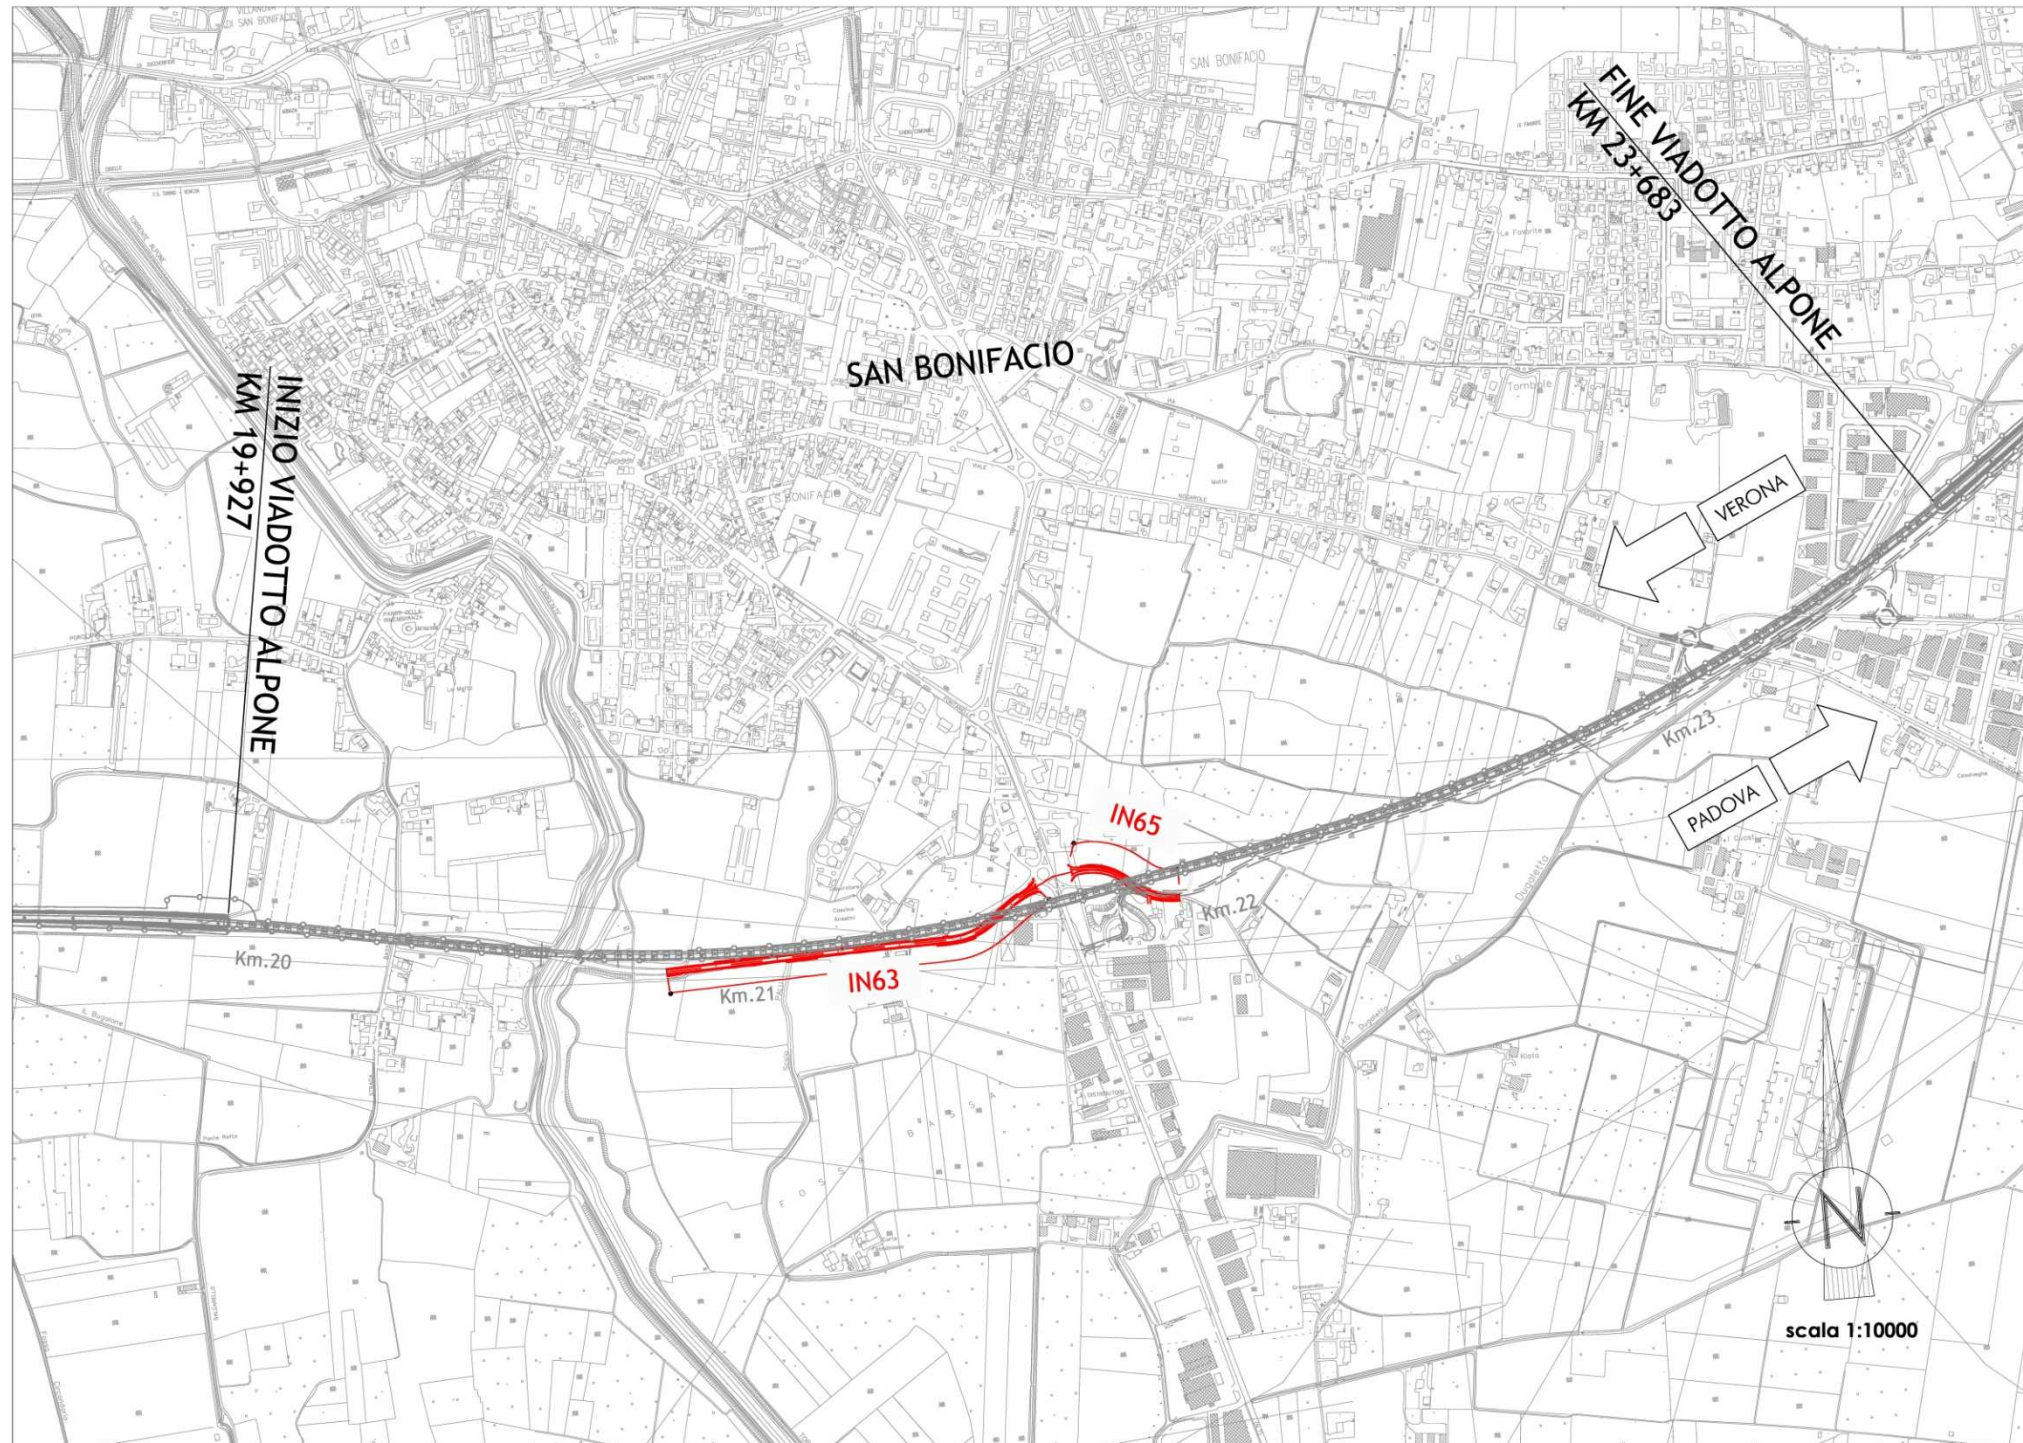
Stralcio planimetrico con individuazione della seconda parte della Porcilana, individuata come IN63 e IN65
